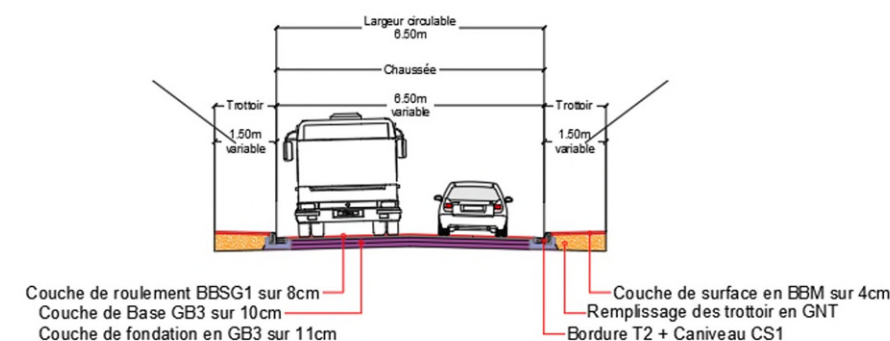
Travaux sur l'avenue du Général de Gaulle (Source : Egis - 2024)
